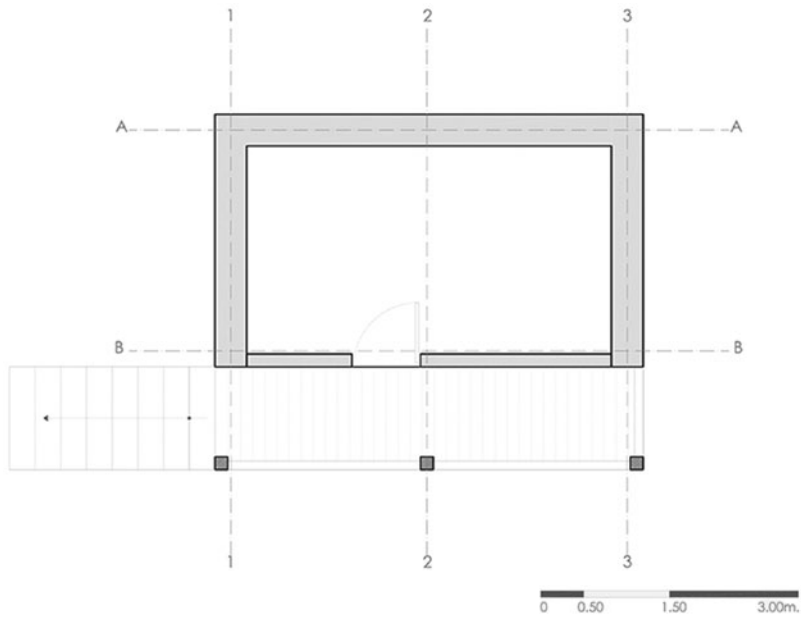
Tipología 1. Parroquia de Gualaceo. Planta rectangular.
